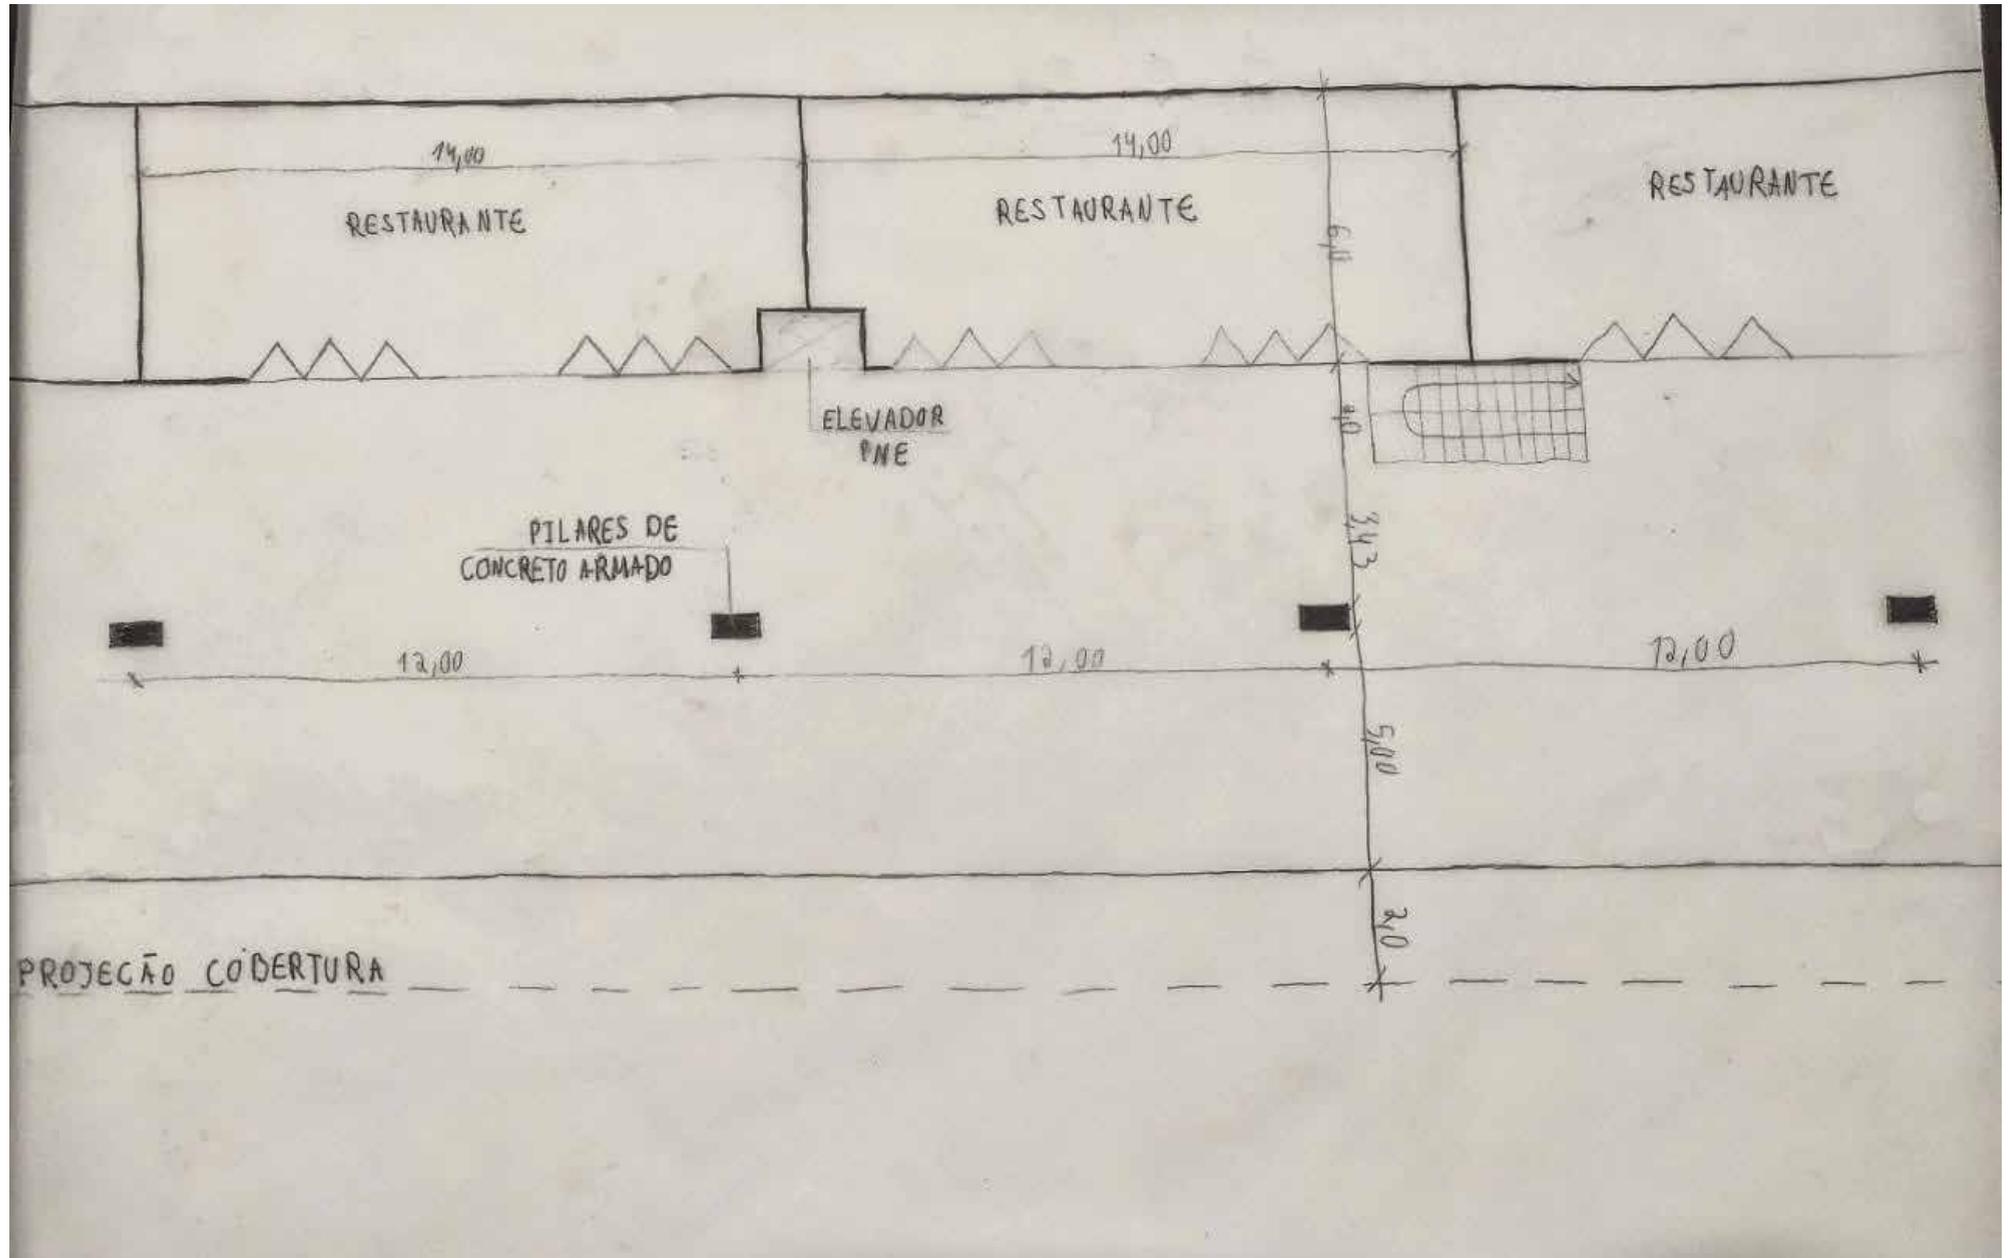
Croqui do pavimento superior da faixa de restaurantes (sem considerar o espaço das cozinhas).
